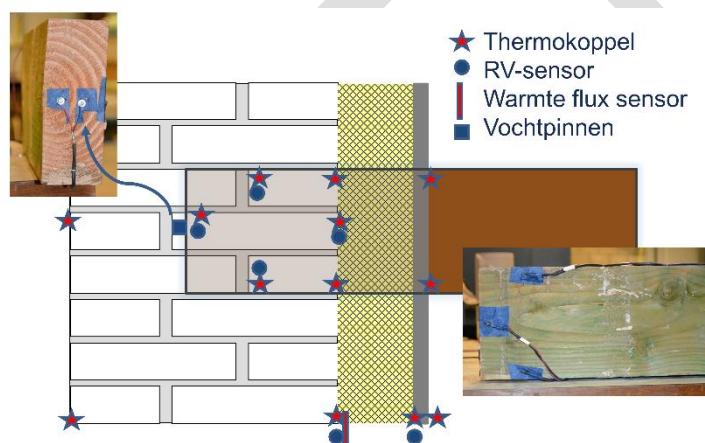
Uitgevoerd aanpassing voor reeks 2: afgetapete balken (bovenste rij balken)
